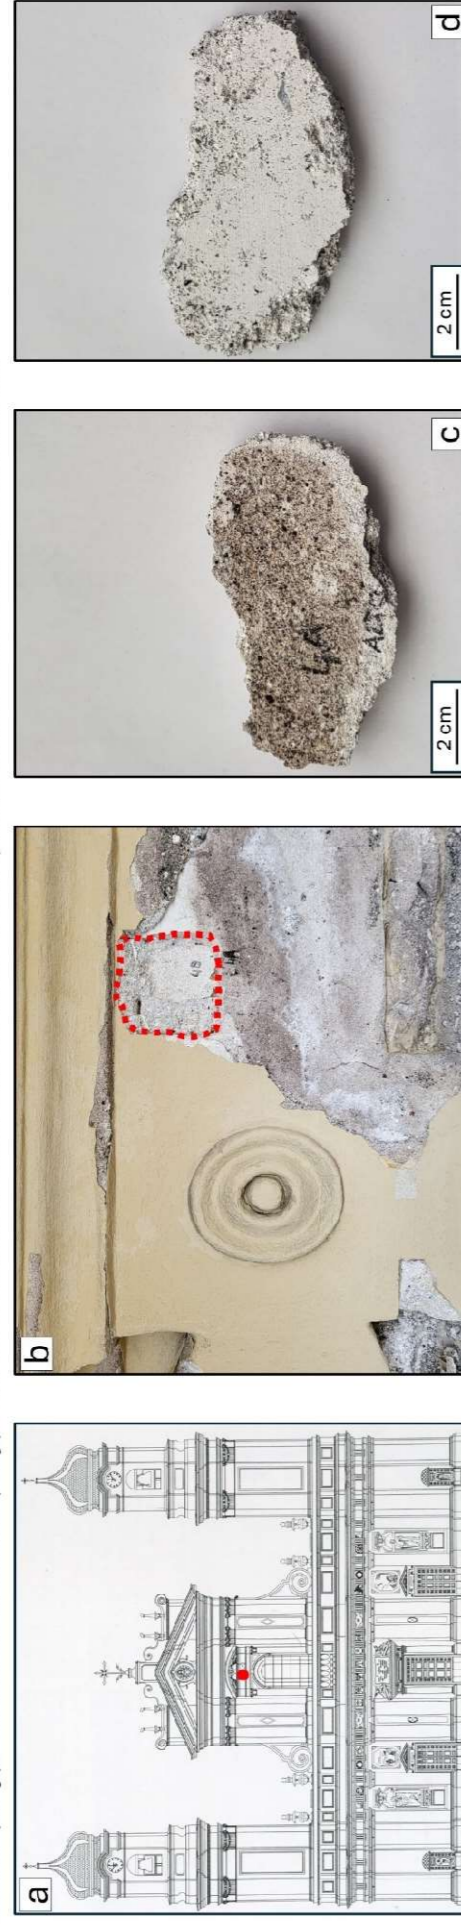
a) posizione campione nel prospetto principale della Basilica; b) punto di prelievo; c) campione C4A (vista dall'alto); d) campione C4A (vista dal basso).
